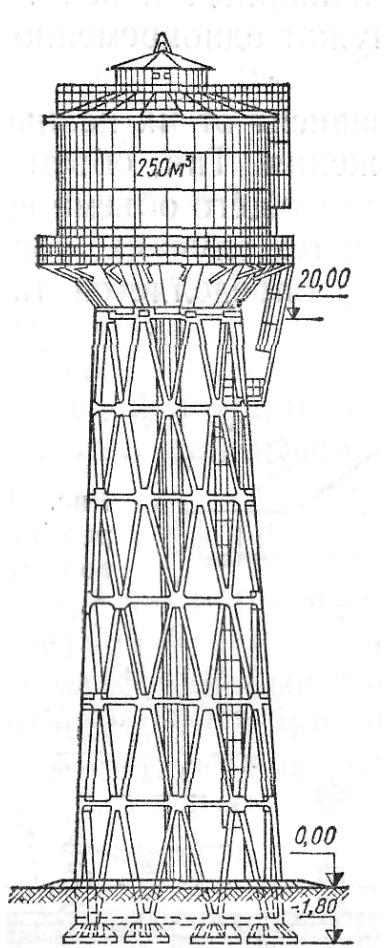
Железобетонная водонапорная башня с опорой из сборных элементов
